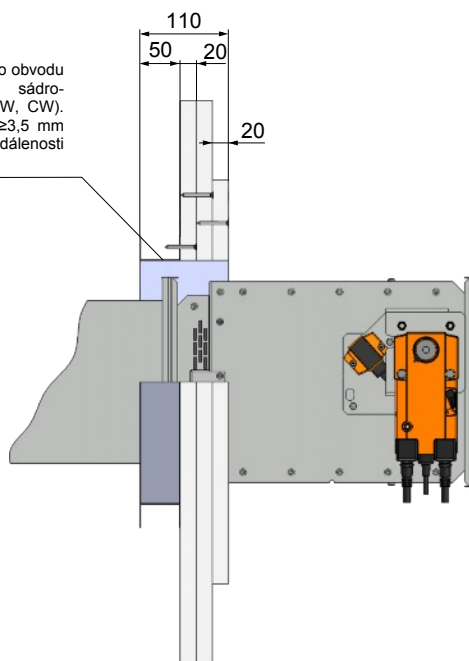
Šachtová konstrukce - sádra nebo malta - ČTYŘHRANNÁ Klapka
